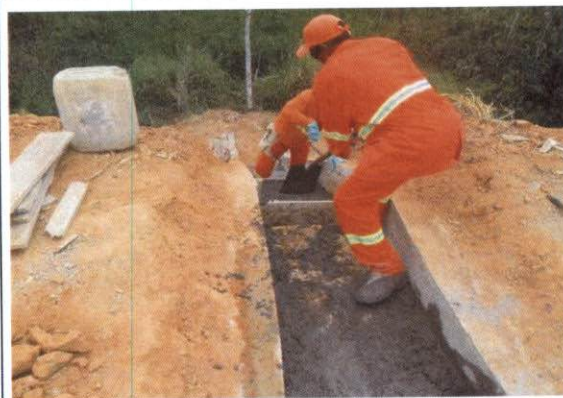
Colaboradores instalando sistema de drenagem no Km 035+ 940.
